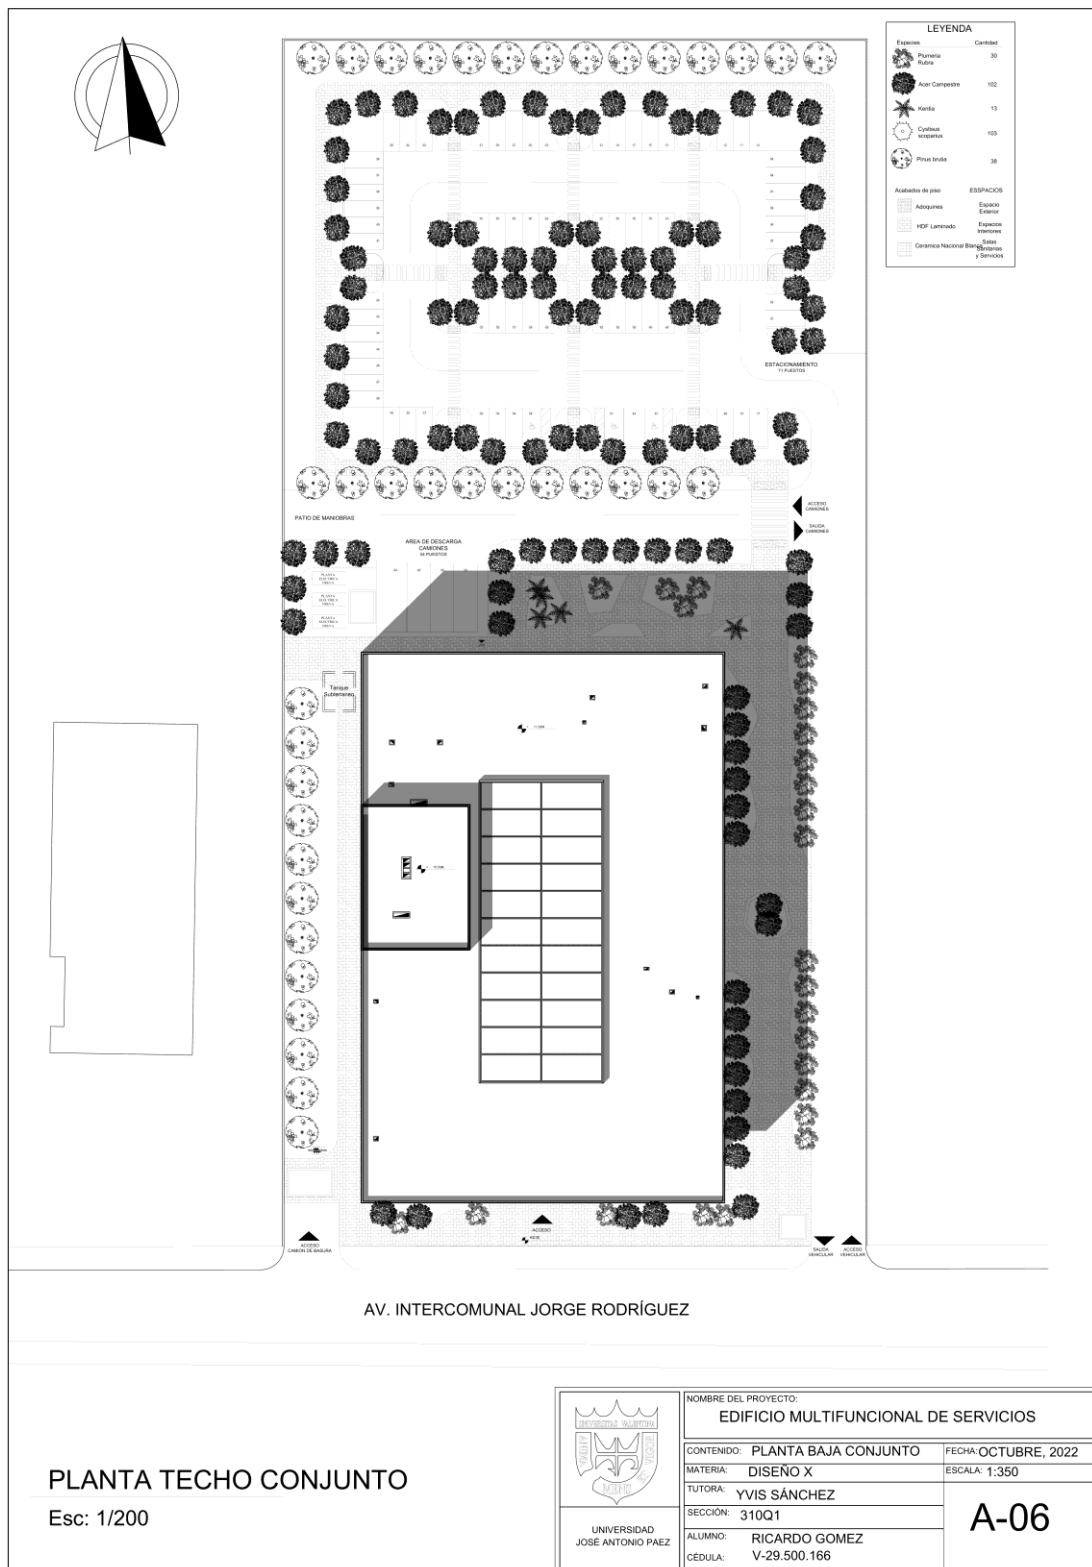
Planta techo conjunto. Fuente: El Autor (2022).
